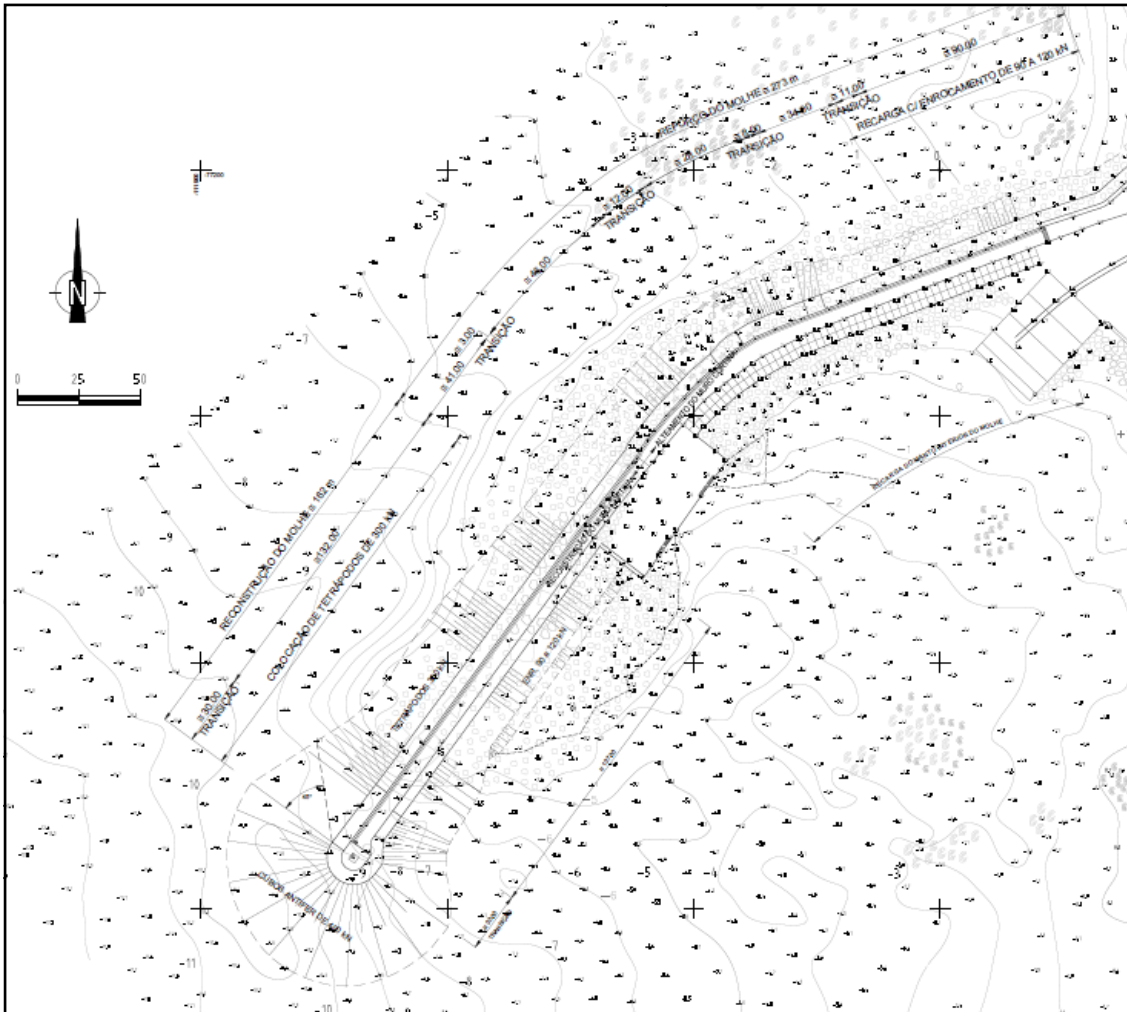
Planta geral das intervenções de reabilitação/reconstrução do molhe da Ericeira
